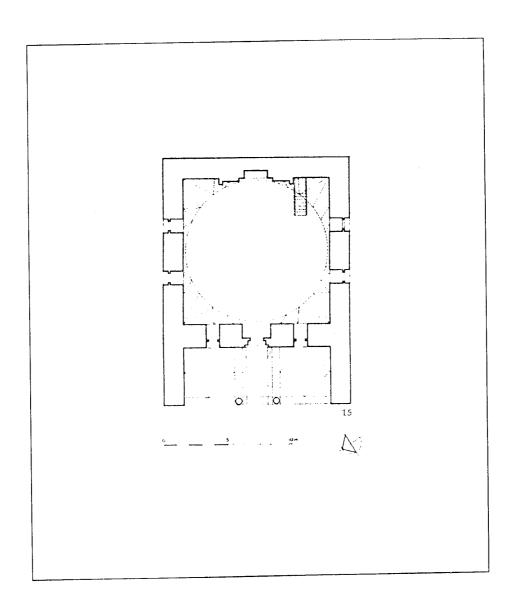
مسقط أفقي لمسجد أحمد باشا هرسك أوغلو في قيشان (عن : اصلان ابا) .
